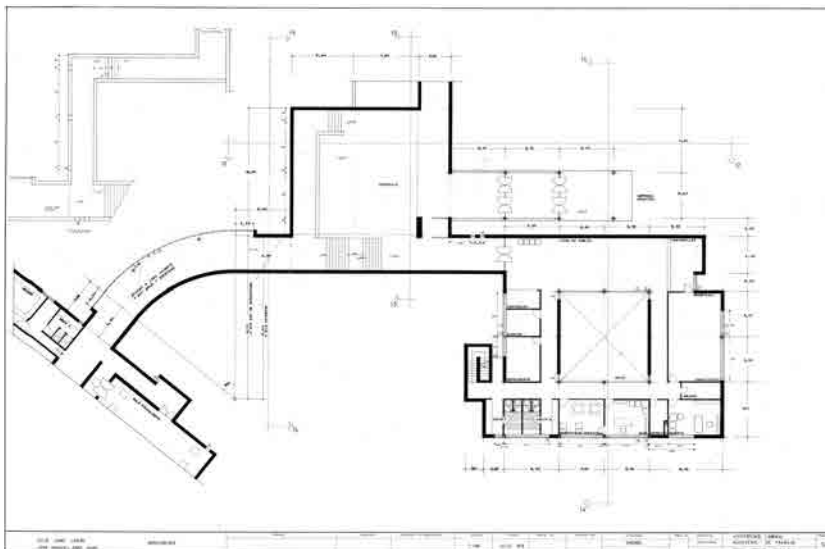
Planta baja de la zona de acceso, vestíbulo y dirección-administración.
